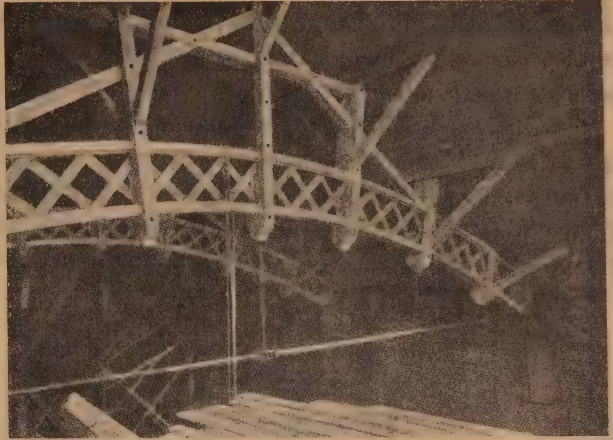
внутренний вид устройства деревянного перекрытия по системе Стефан, с показанием конструкции для перехода от арки к двухскатной крыше.
